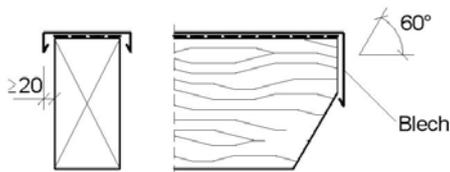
Holzträger mit Blechabdeckung, Quer- und Längsschnitt. Die seitlichen Überstände sollten mindestens 20 mm betragen. Bei Durchdringungen mit Schrauben ist eine Abdichtung einzubauen.
